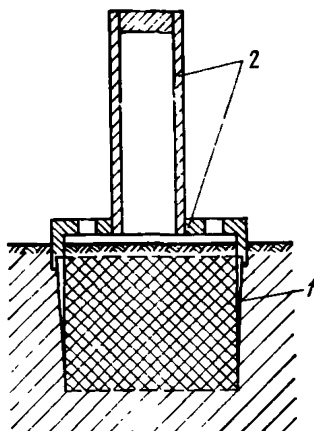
Схема отбора проб грунта режущим цилиндром (прибор Ковалева)
